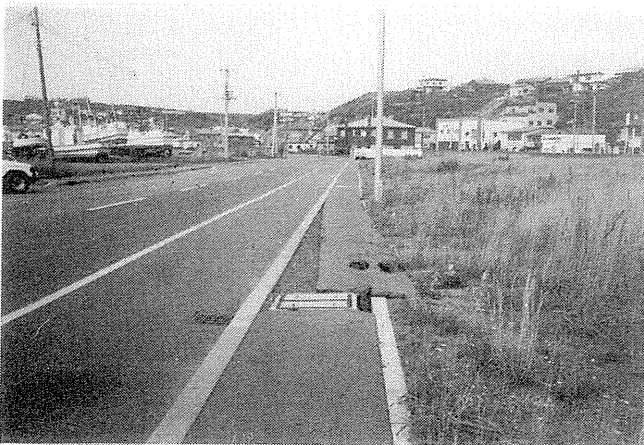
花咲港地区Dのアスファルト舗装の移動
